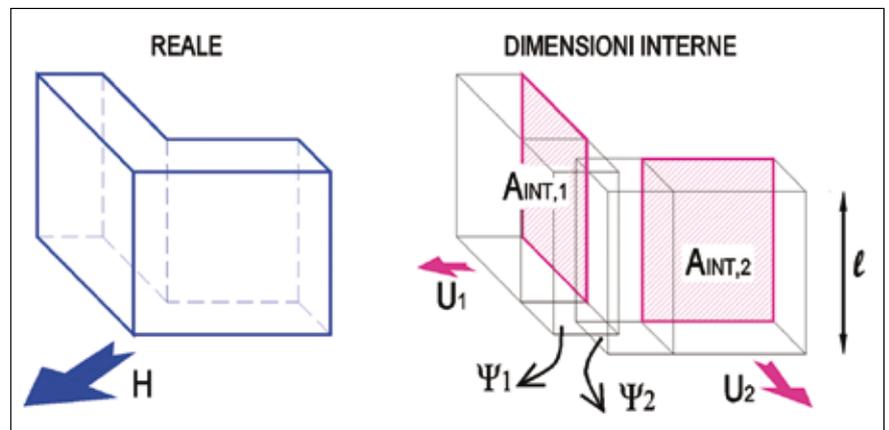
Pilastro d'angolo nella muratura con le dimensioni interne
